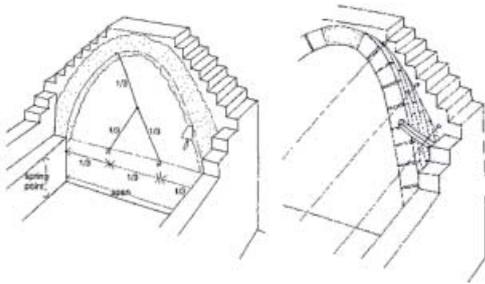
Alternativas al sistema de trazado y construcción de una bóveda nubia: trazado con cables y cables guía. (Fuente: JOHN NORTON, *Development Workshop. Woodless Construction. Unstabilised Earth Brick Vault and Dome Roofing without Formwork. Volume 9 · Number 2. p 21 y 22*).
